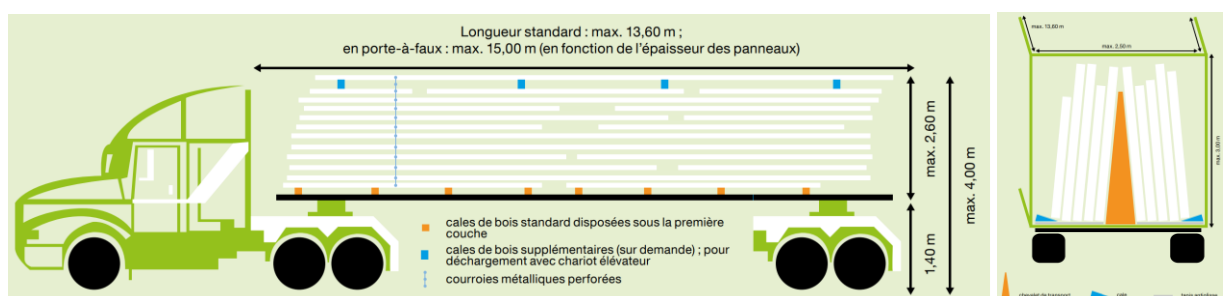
Transport de panneaux Stora Enso CLT en position horizontale et verticale
